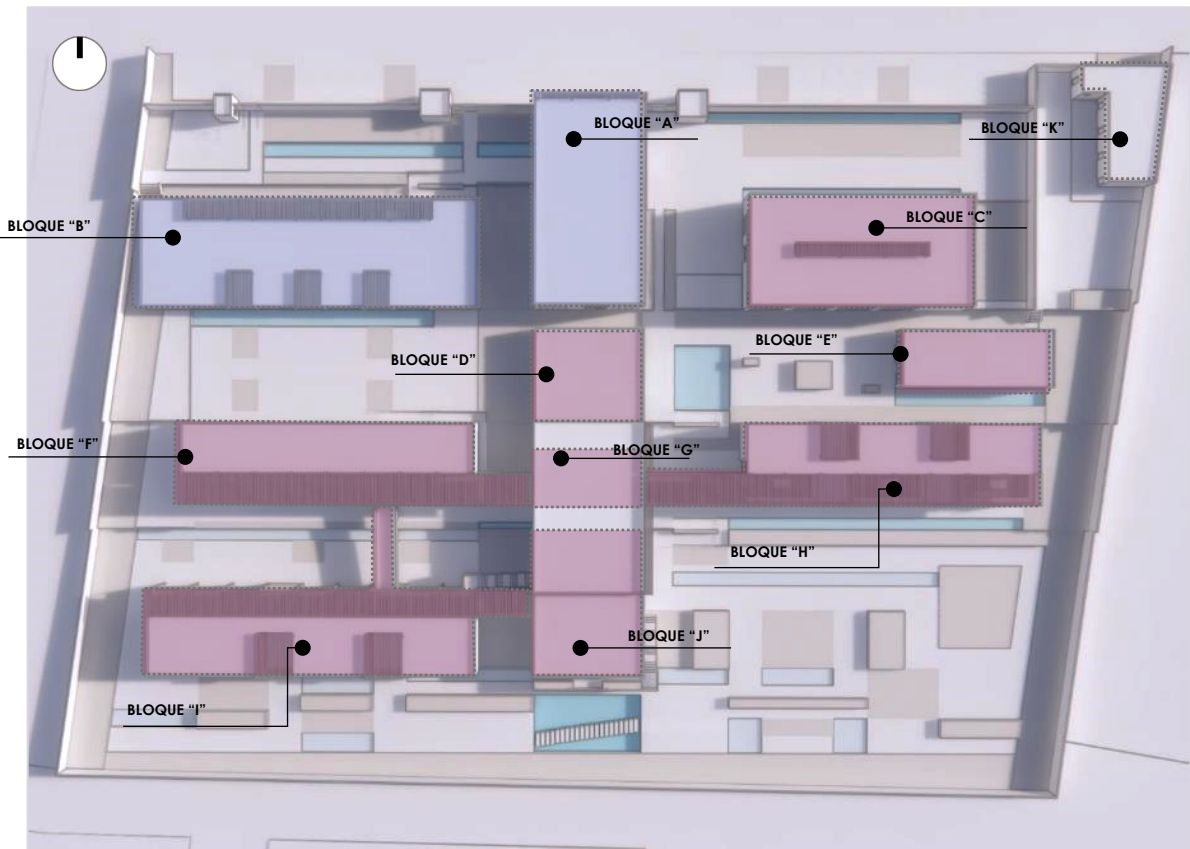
Plot plan de ubicación de bloques estructurales del proyecto
